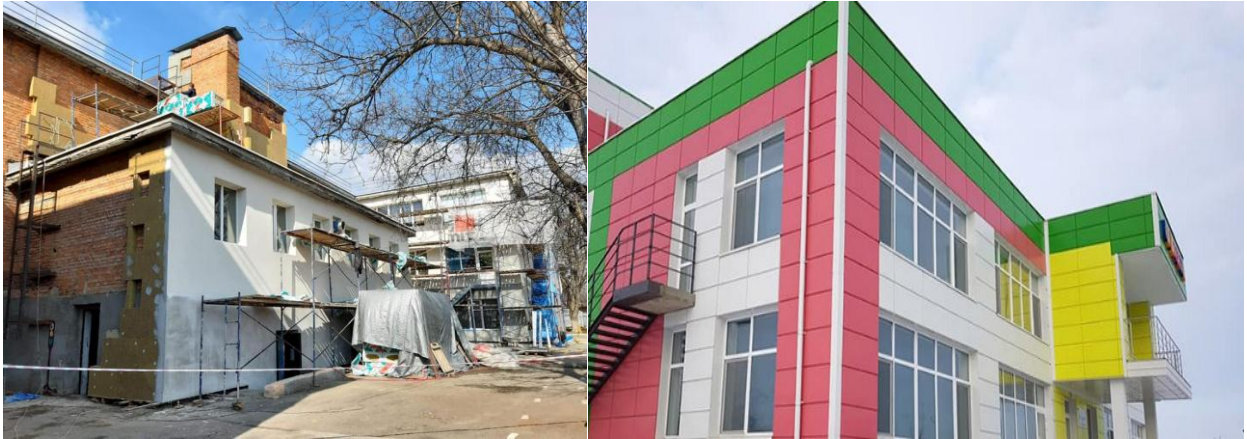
Утеплення методом скріпленої теплоізоляції та методом вентиляваного фасаду
